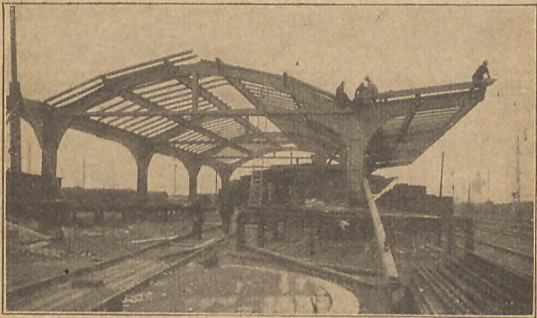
Bahnsteighalle Erfurt. (Aus Otto Hetzer A.-G., Weimar: „Freitragende Hallen und Dachkonstruktionen“.)
